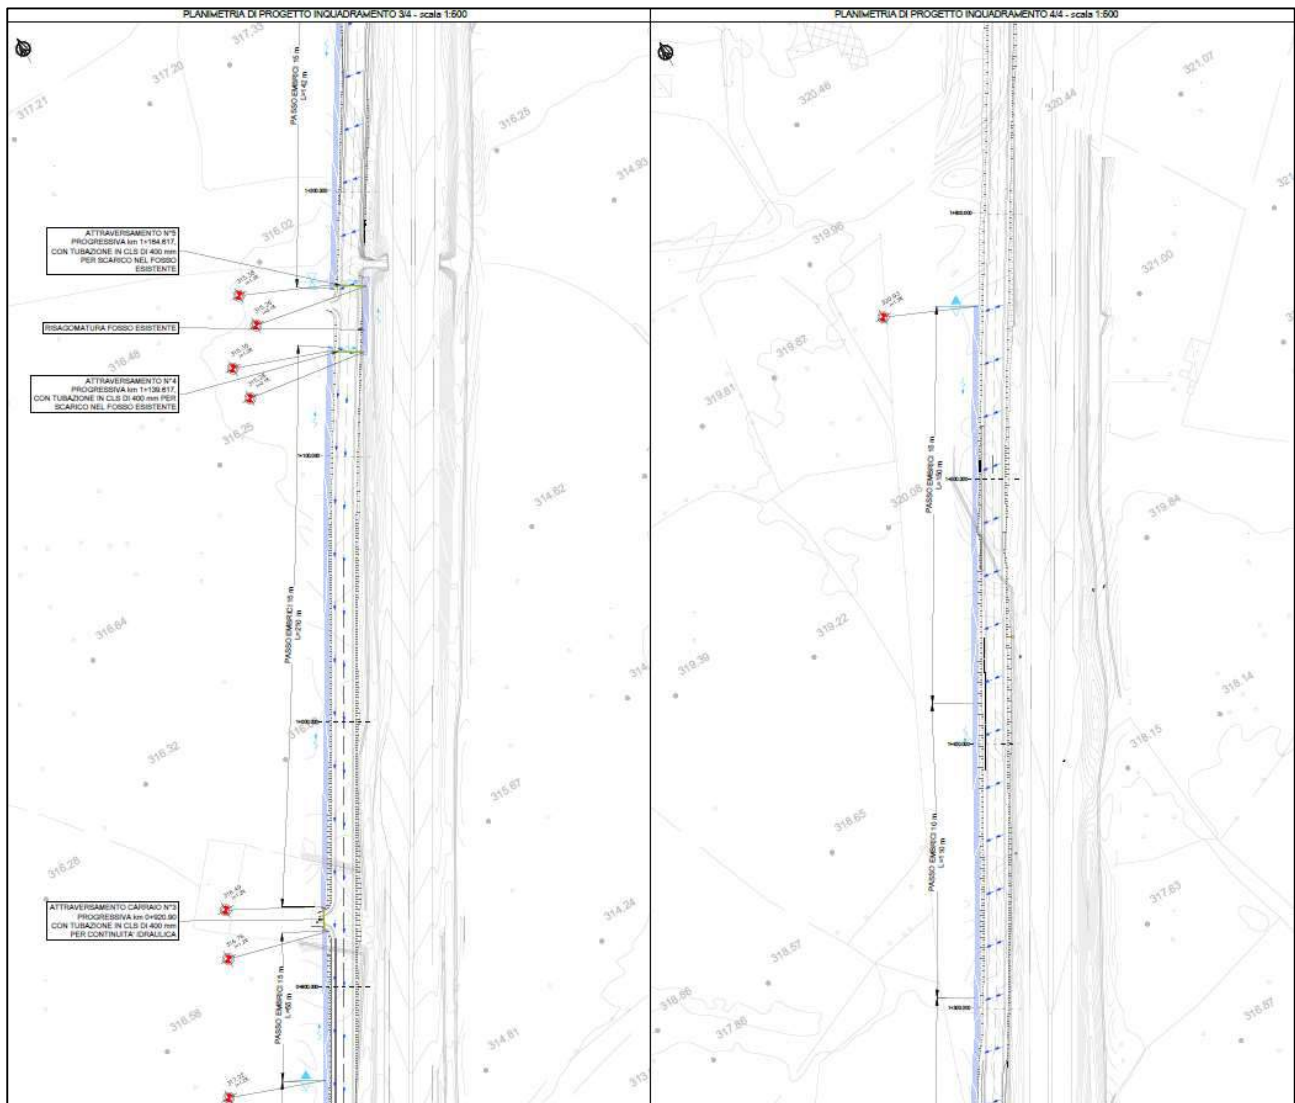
Stralcio planimetrico intervento S04-Risoluzione accesso C.S. al km 115+205, inquadramenti 3/4, 4/4
